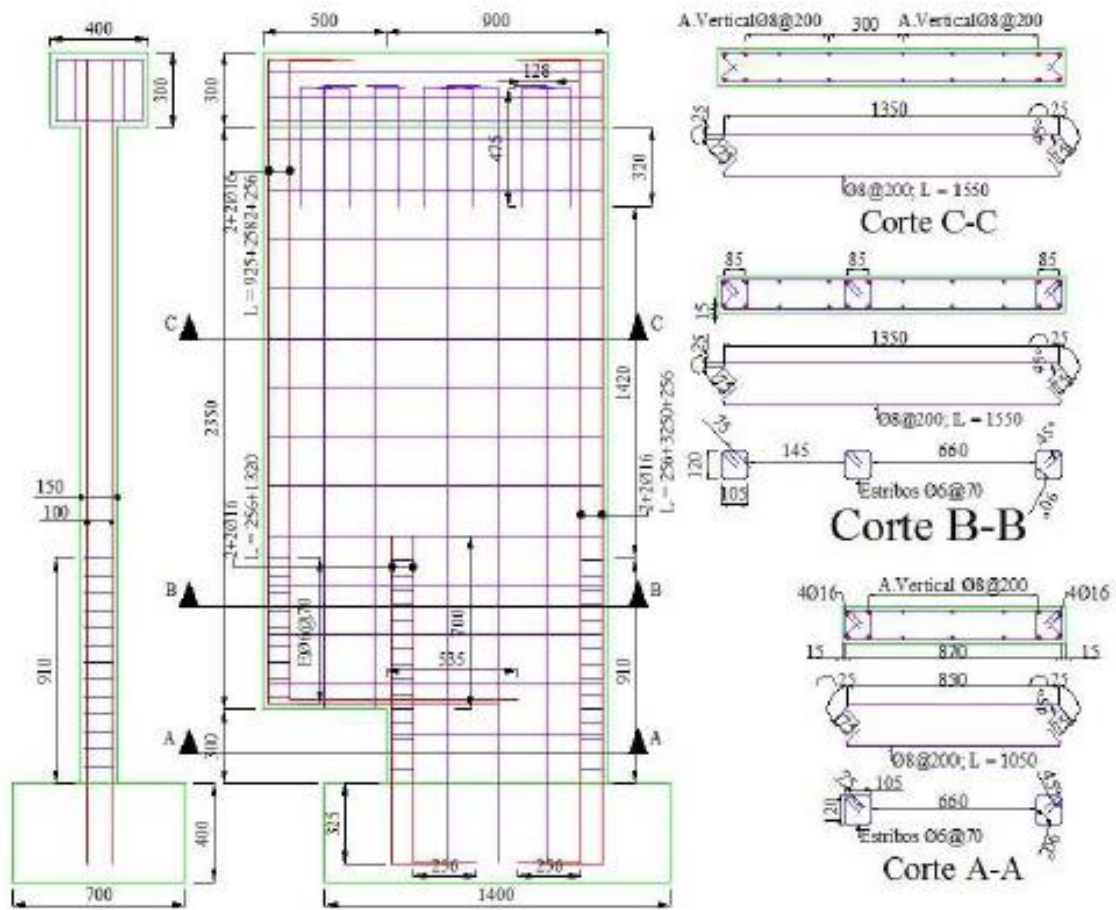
Detallamiento de la armadura de la probeta 2 de muros bandera.
